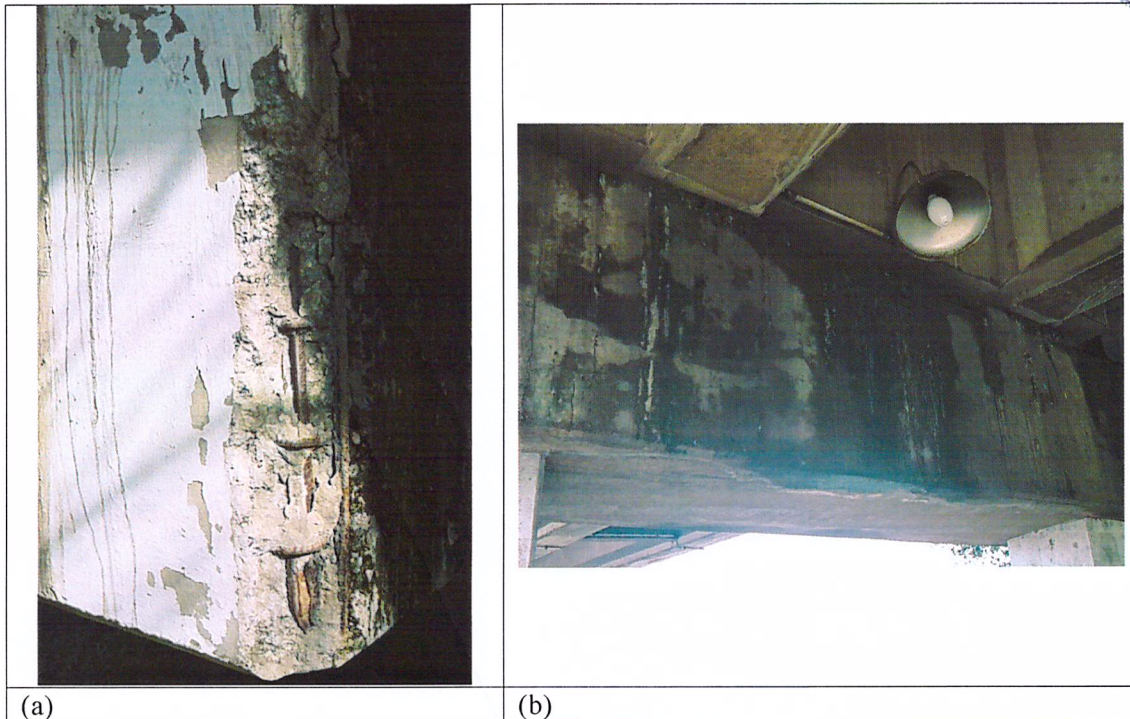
(a) quina quebrada com armadura exposta. (b) fissuras verticais e a presença de limo;
